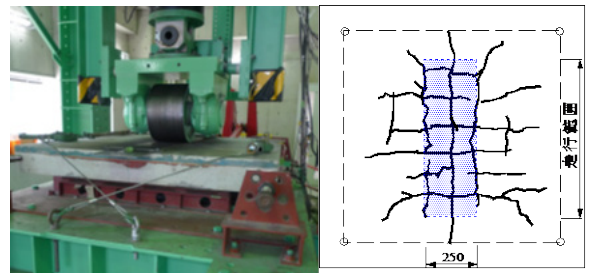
輪荷重走行実験 図-2 予備载荷（ひび割れ）
